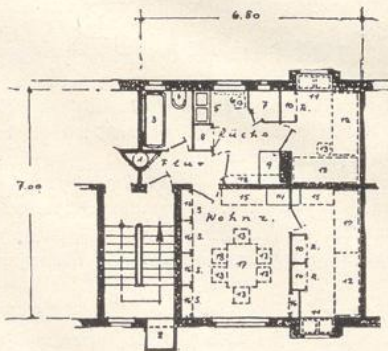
Grundriß einer Kleinwohnung. (1:200.)
